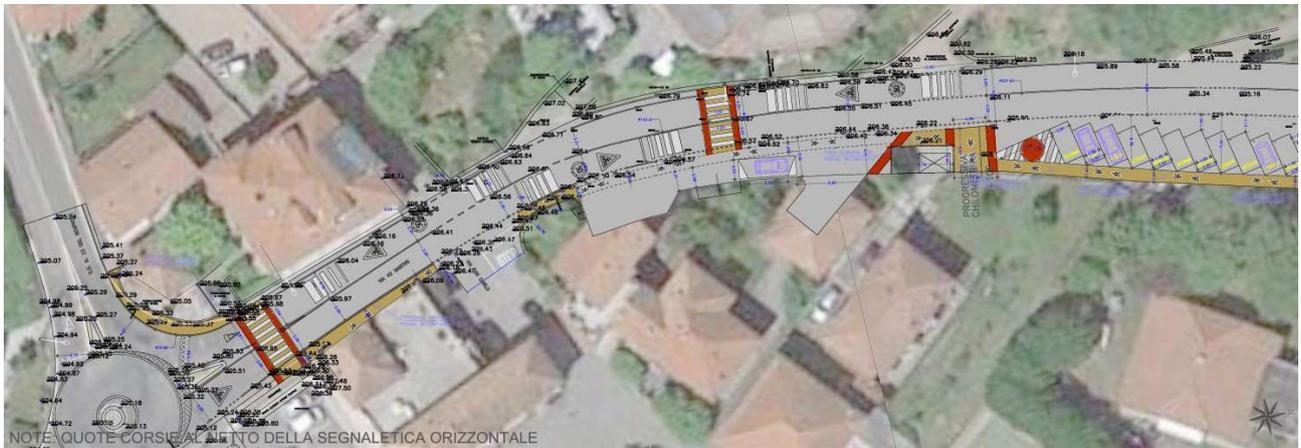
ANDAMENTO PLANIMETRICO VIA 42 MARTIRI – TRATTO SUD
